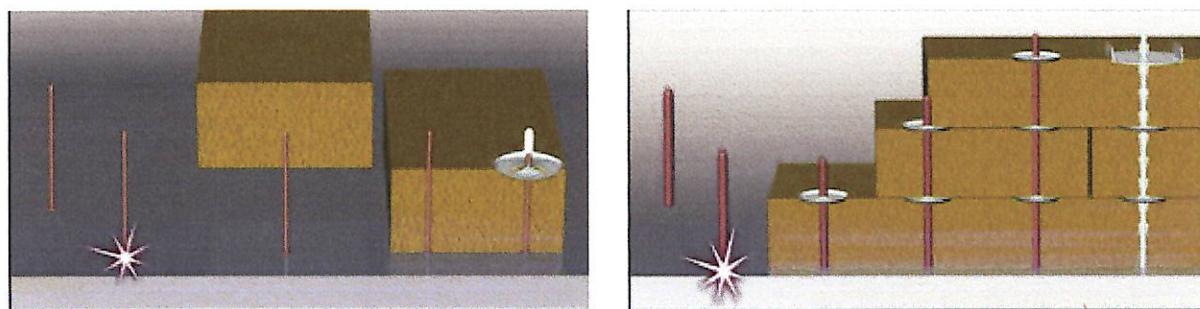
Схема розташування плит по периметру повітроводу прямоугольного перетину при одному шарі плит
